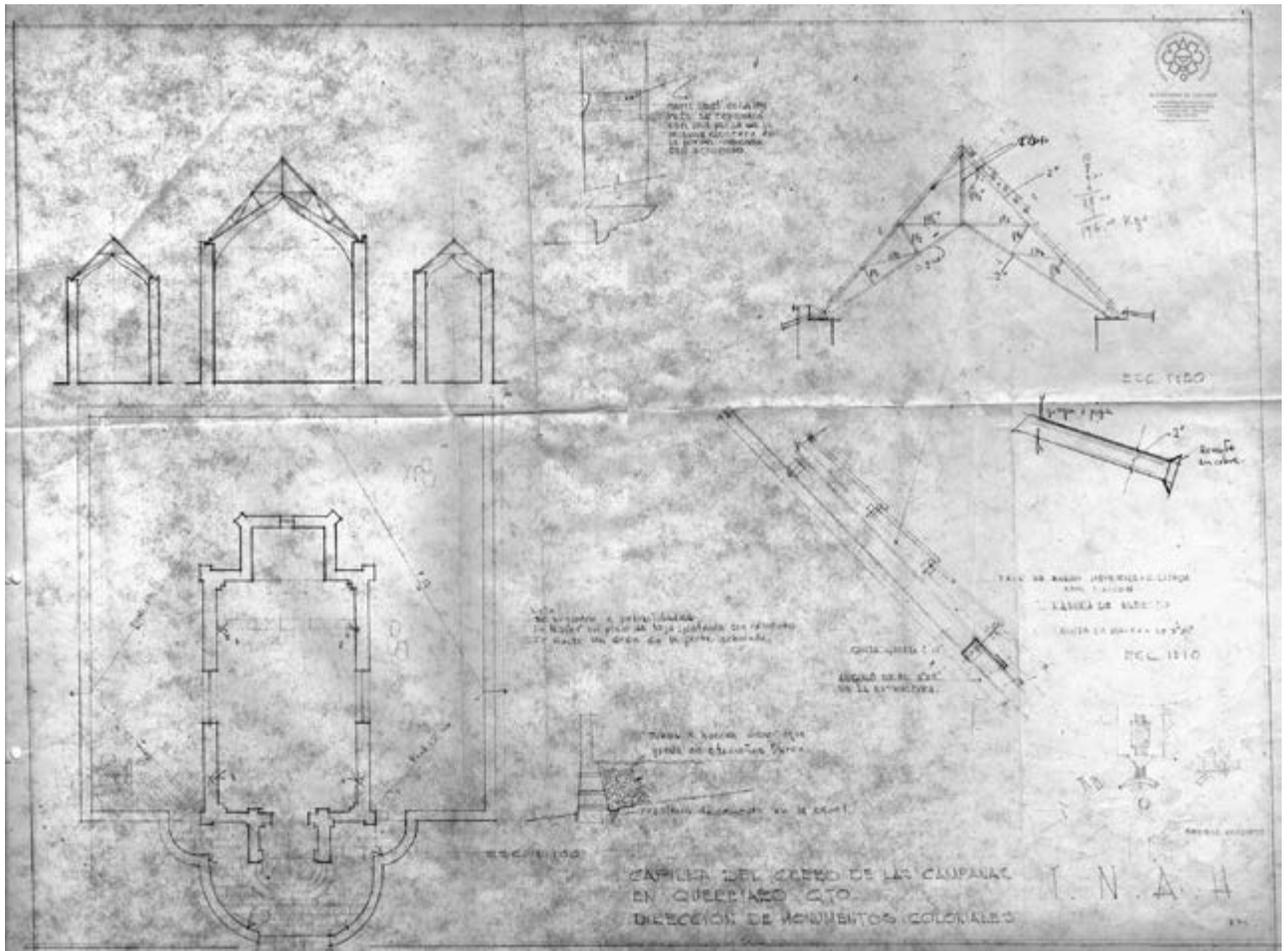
Plano de la Capilla del Cerro de las Campanas. Levantamiento arquitectónico, s/f, realizado en el Departamento de Monumentos Coloniales-INAH; contiene detalles constructivos, AHJE, CNMH, exp. Capilla del Cerro de las Campanas.
